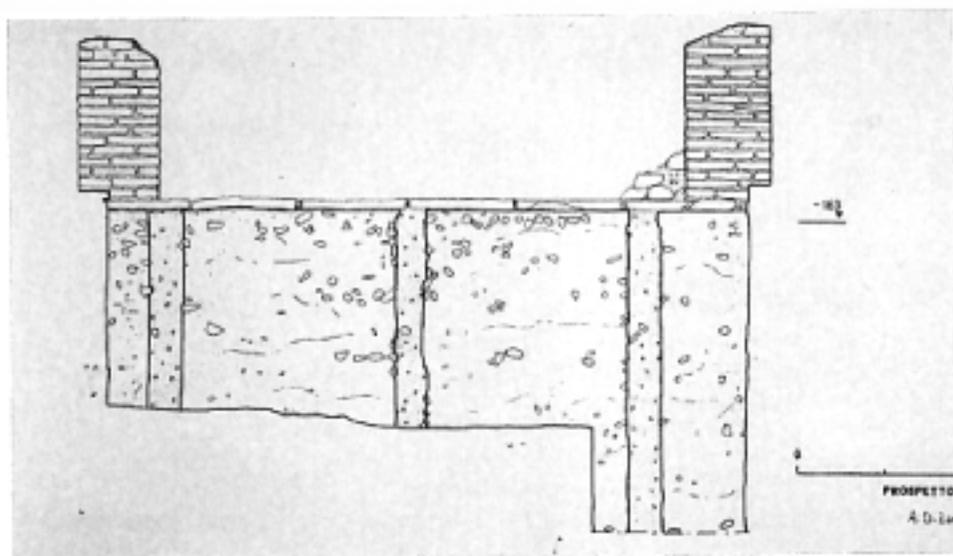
Prospetto delle fondazioni della platea orientale (Foto G. De Felice).
